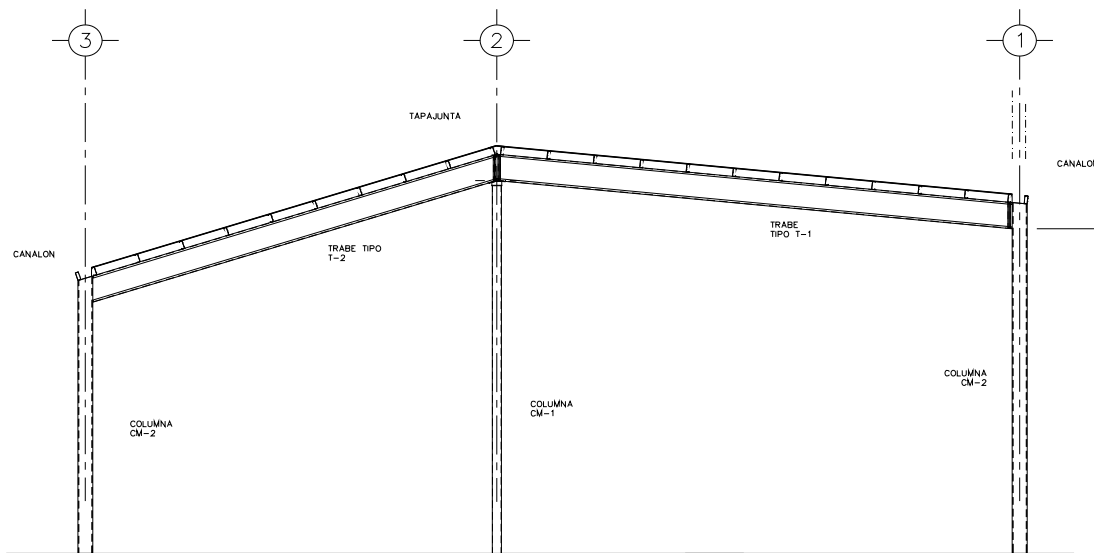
Marco rígido con vigas de alma cerrada.
